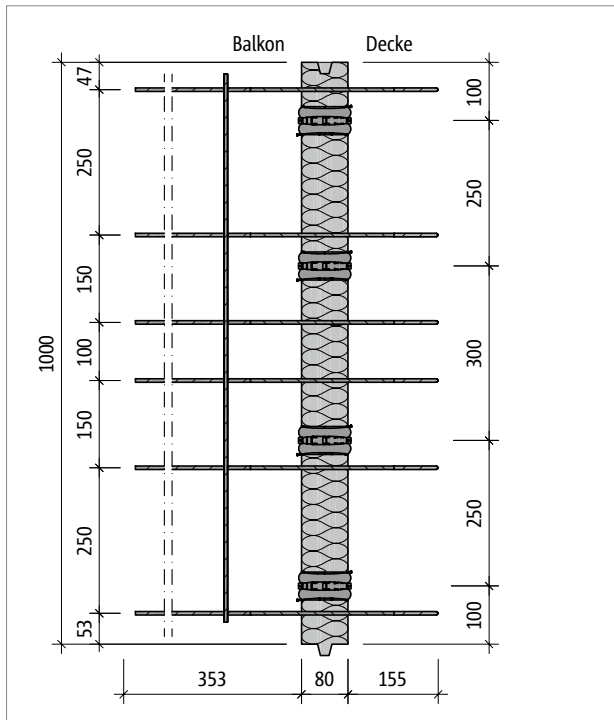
Schöck Isokorb® T Typ QL-V1: Produktgrundriss
